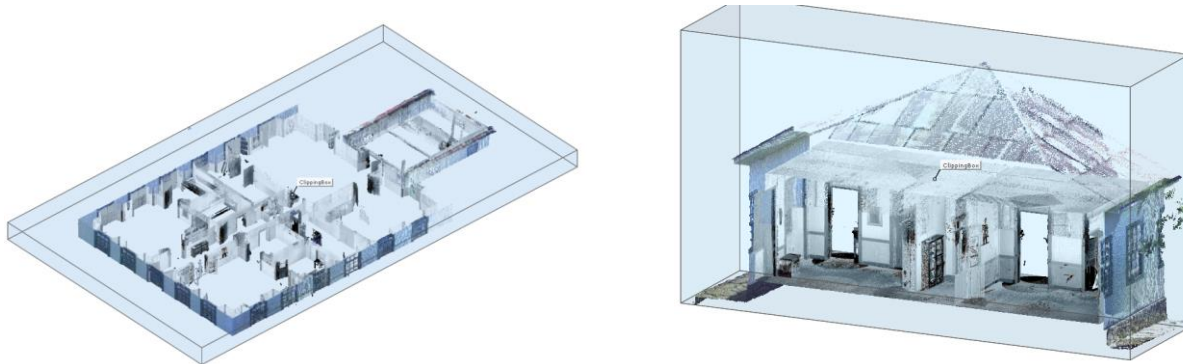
Exemplos de Caixa de Recorte para geração de ortoimagens. À esquerda, recorte de paredes externas/internas com altura nas esquadrias para planta baixa. À direita, recorte de fachada pelo lado interno.
